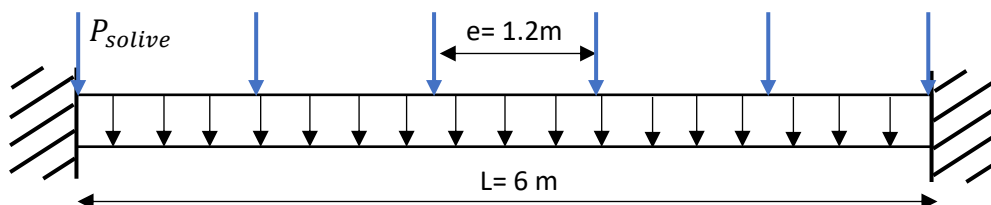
Schéma de la poutre principale d'une longueur de 6m
